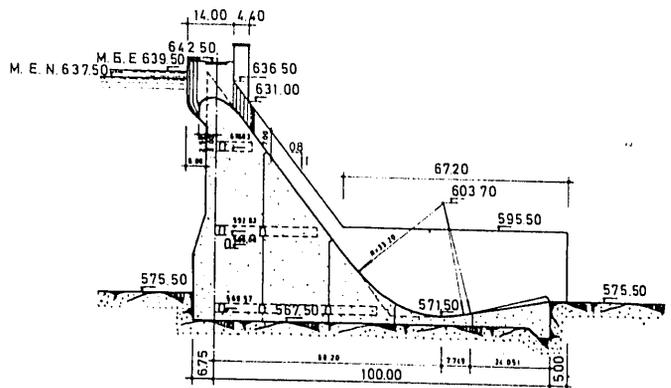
Sección tipo de la presa de gravedad-aliviadero.
